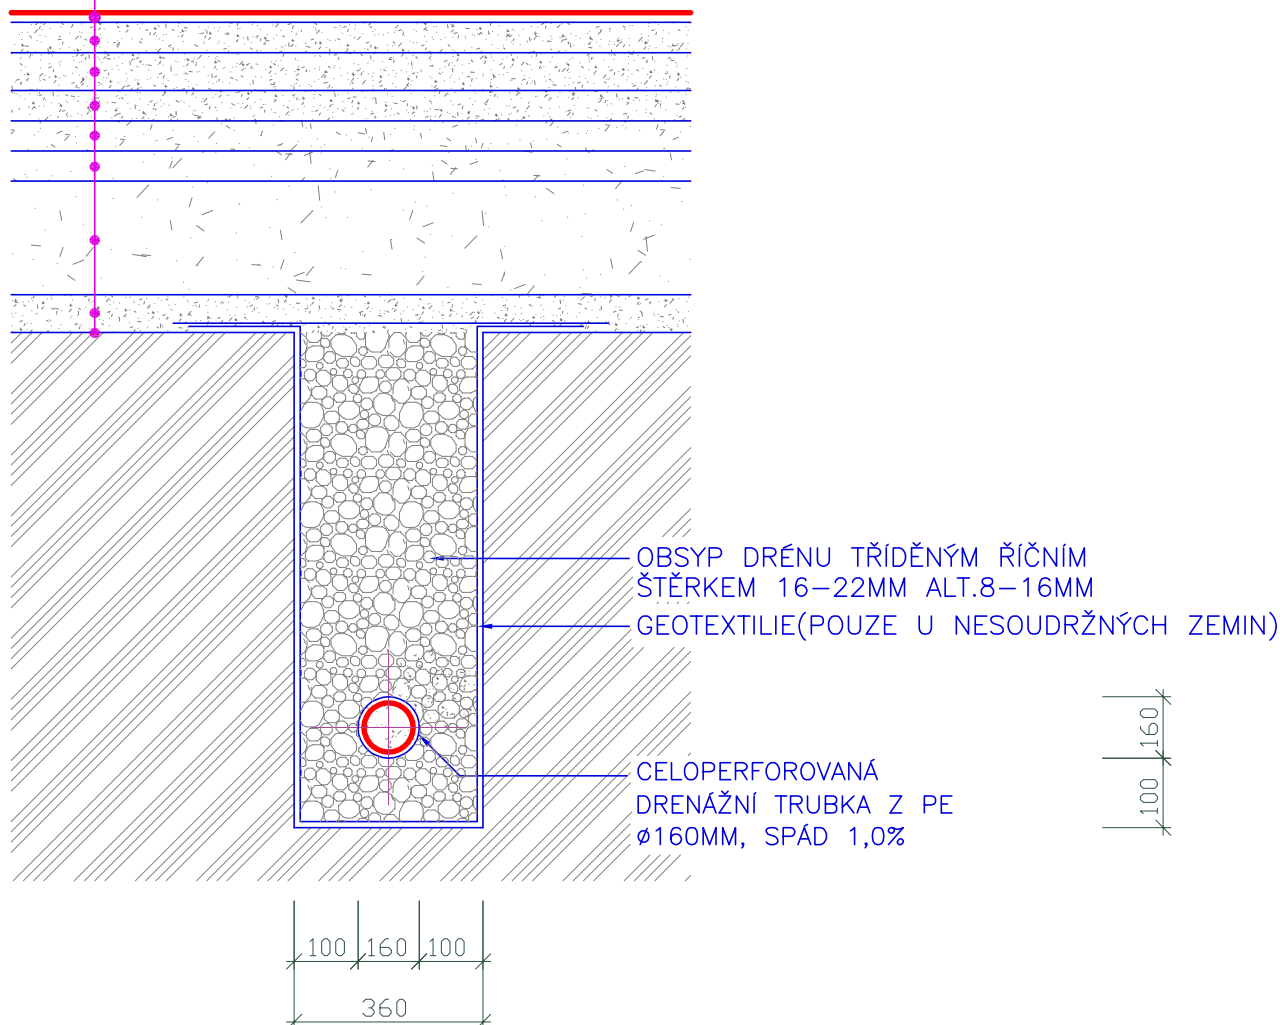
DETAIL E-FLEXIBILNÍ DRÉN M 1:10
